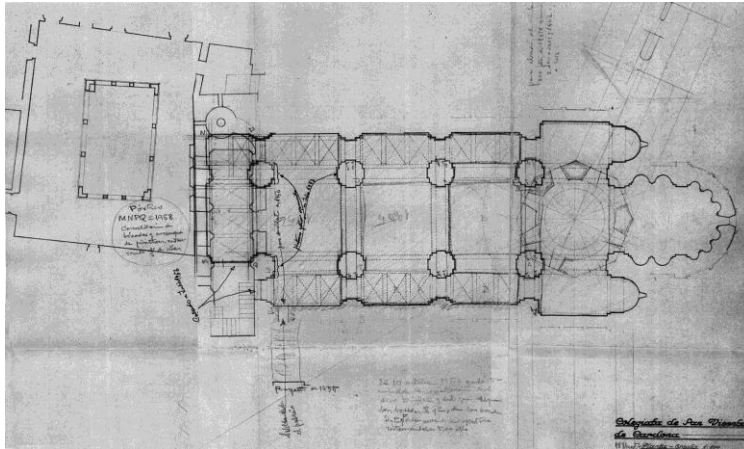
Cardona. Colegiata de San Vicente AAFV. Plano de planta. Utilizado para fechar obras posteriores y con anotaciones
